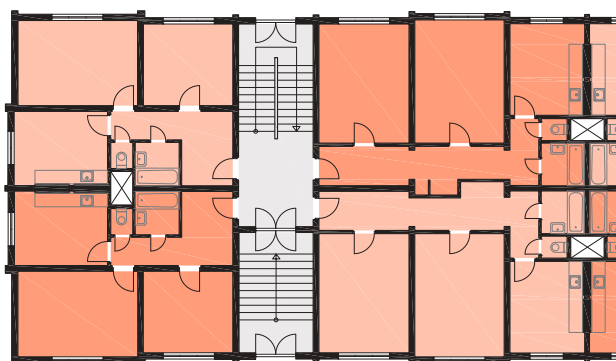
Konstrukční soustava G40, Zlín - Benešovo nábřeží (Zdroj: panelaky.info)
